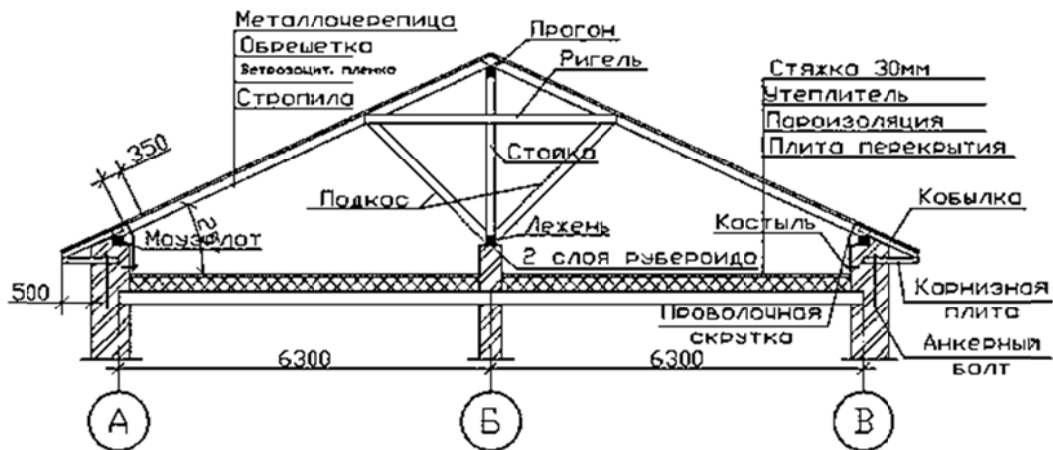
Конструкция скатной крыши по наслонным стропилам
